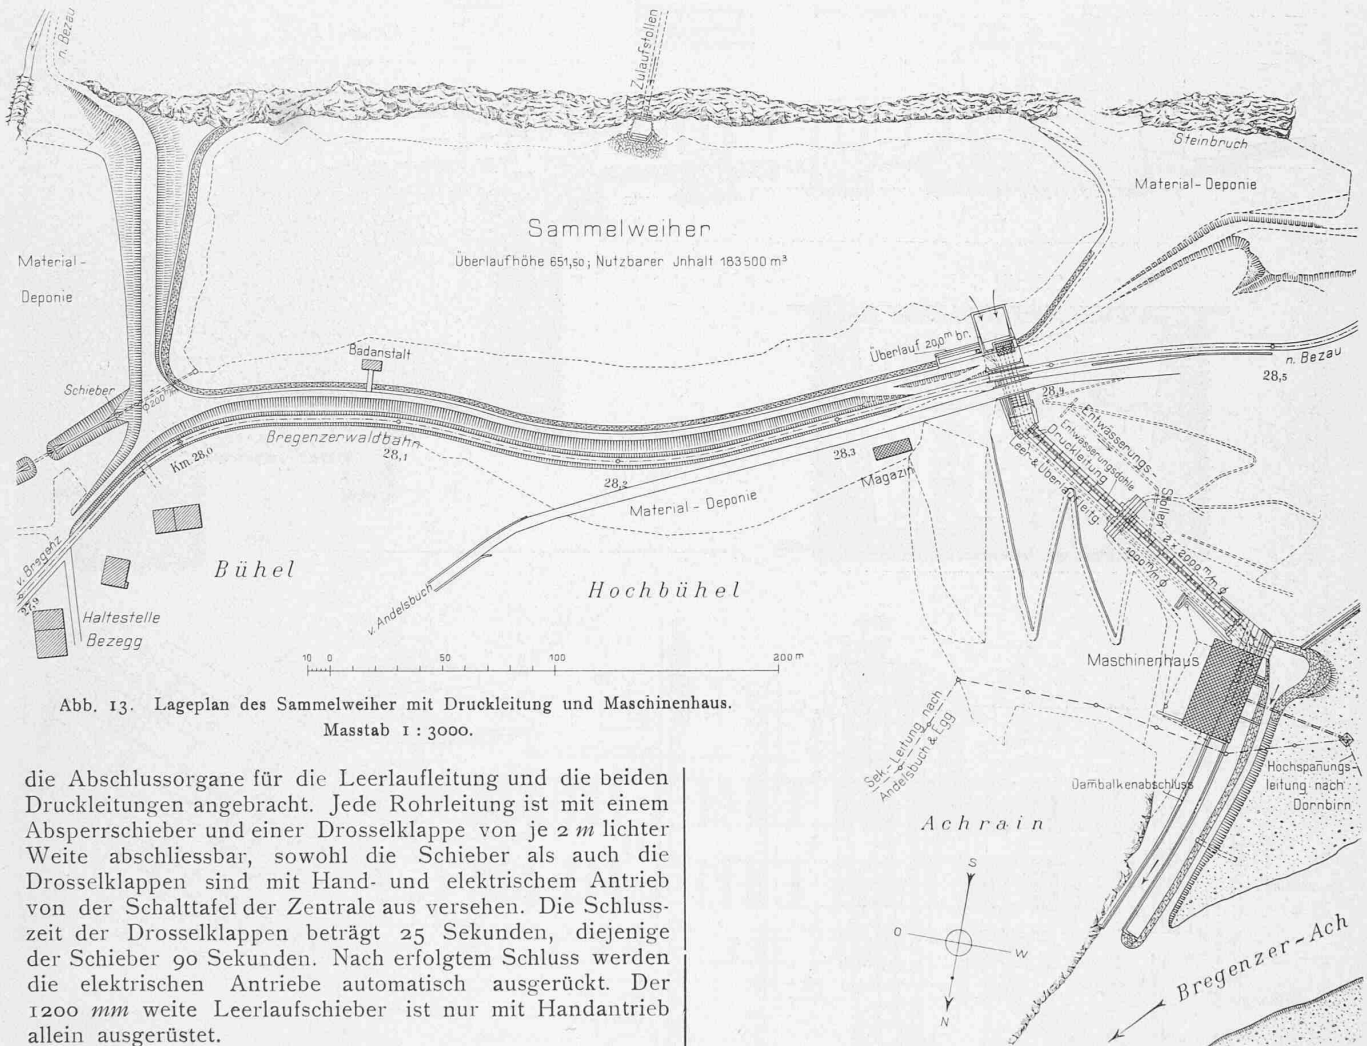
Lageplan des Sammelweiher mit Druckleitung und Maschinenhaus. Masstab 1 : 3000.
